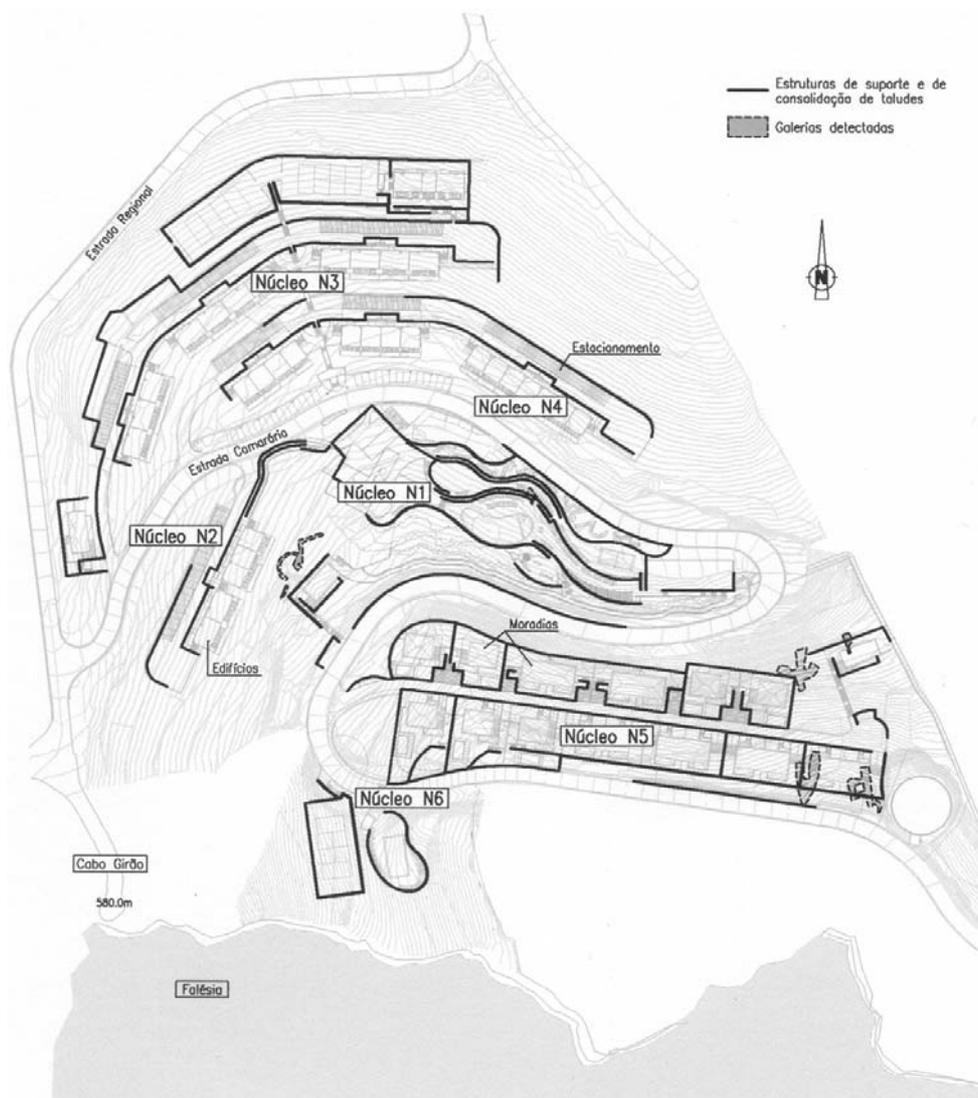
Planta do Aldeamento Turístico Cabo Girão
